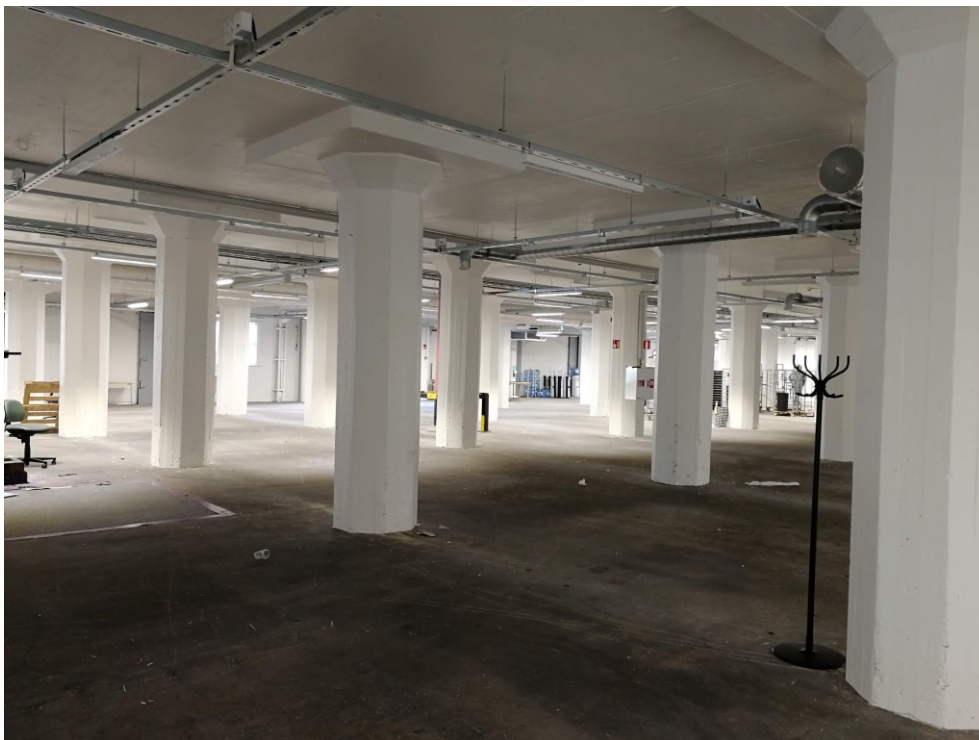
Utrymmets egenskaper är ett tätt, bärande "pelarrutssystem" och ett stort stomdjup. Bild AFRY Finland Oy.
